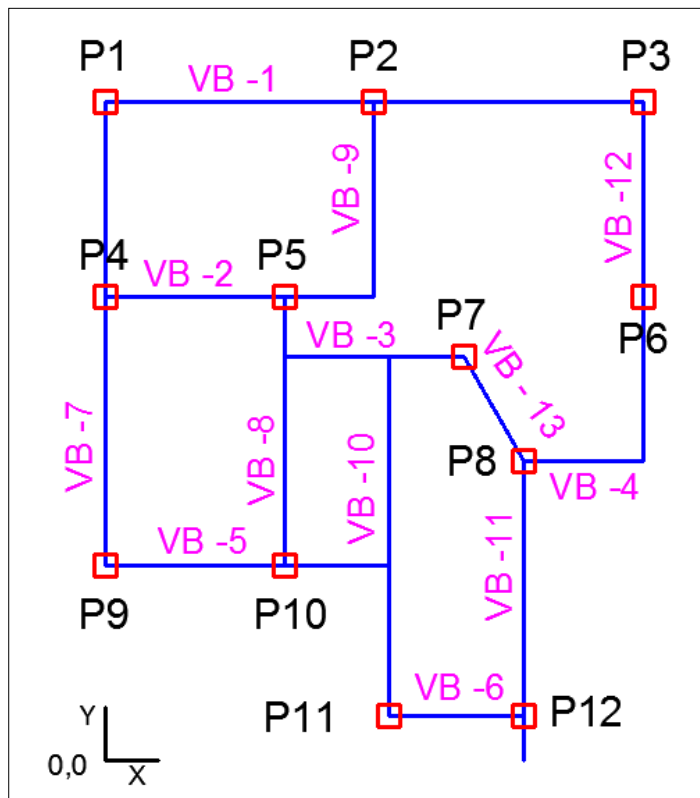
Planta baixa das fundações do edifício Colubandê 2.
